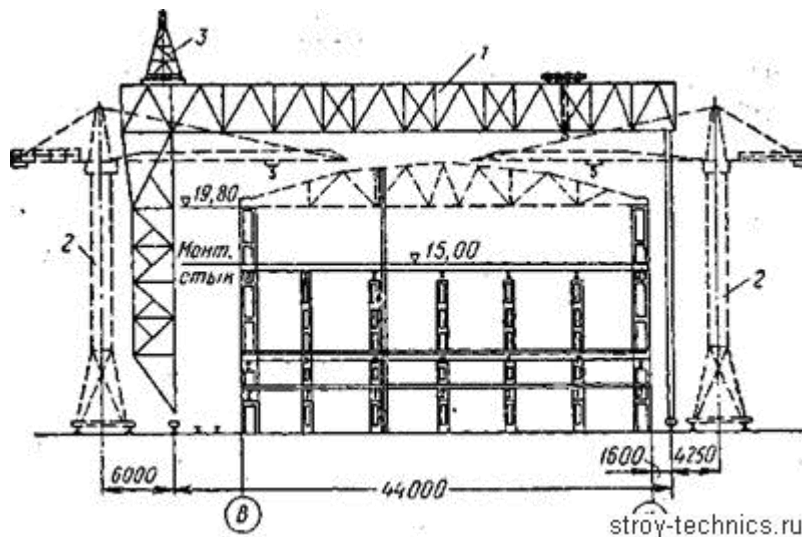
Схема расстановки кранов при монтаже главного корпуса сахарного завода: 1 — козловой кран К-183М; 2 — башенный кран БК.СМ-5-5А; 3 — передвижной шевр для установки плит покрытия
